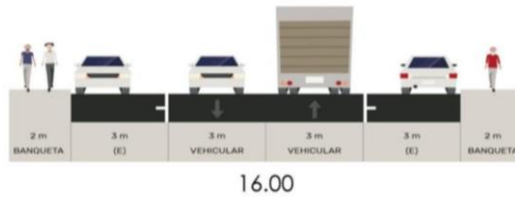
Av. Nueva España y su sección vial actual. Fuente PDU 2040 vigente.
